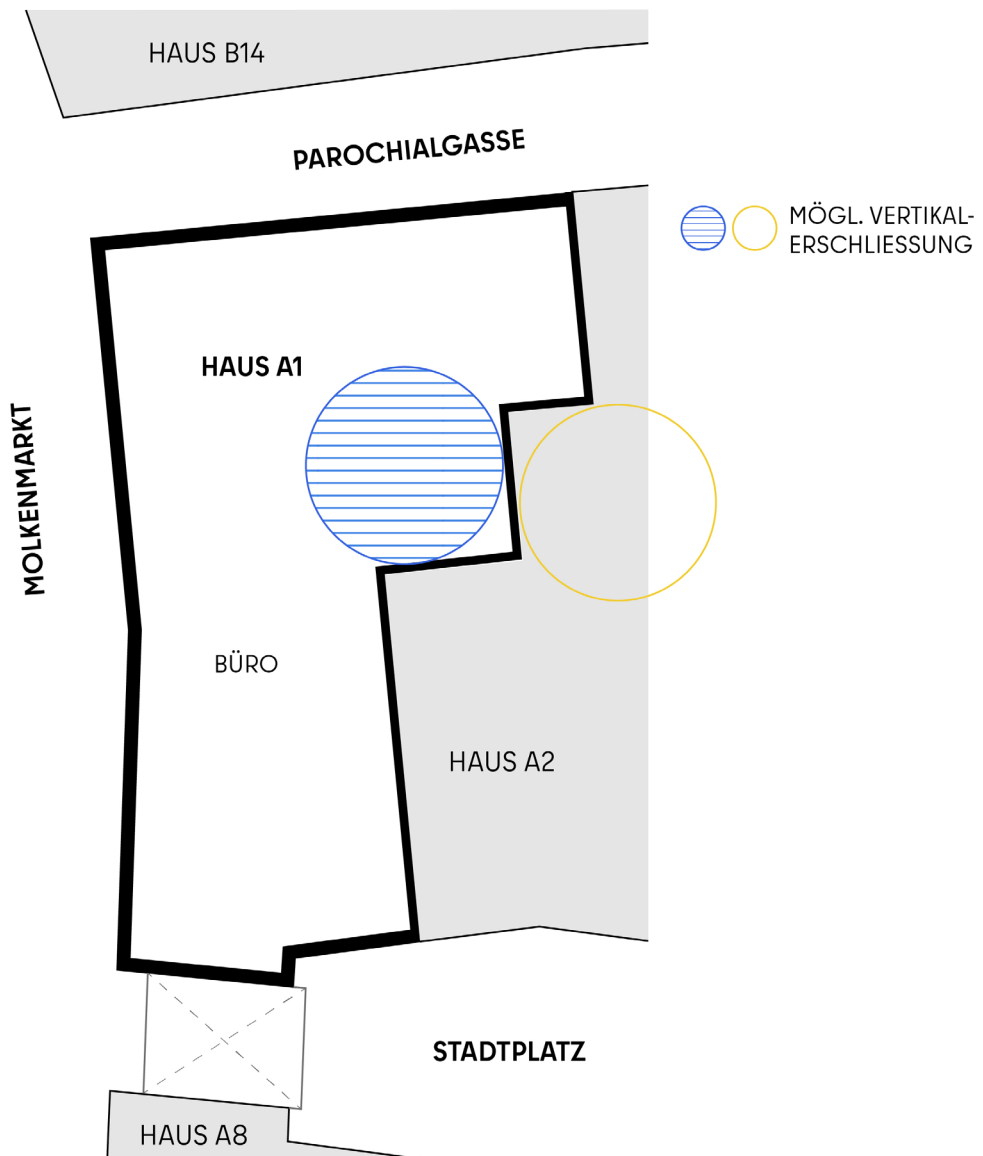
Schematischer Grundriss Regelgeschoss
